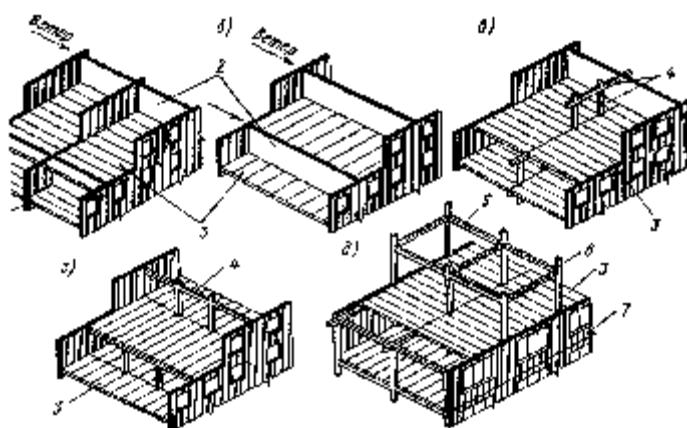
Конструктивные схемы зданий: 1 – внутренняя продольная стена; 2 – внутренние поперечные стены; 3- панели перекрытий; 4 – стойки и прогоны; 5 – прогоны (или распорки); 6 – стойки каркаса; 7 – ненесущие наружные стены.
